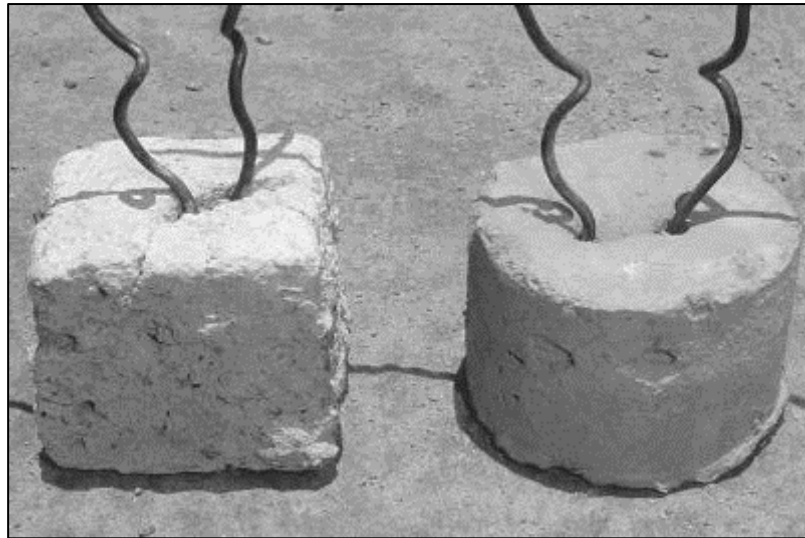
Instalación de separadores previo a la fundida de la losa en concreto. Fuente: separador_concreto.
